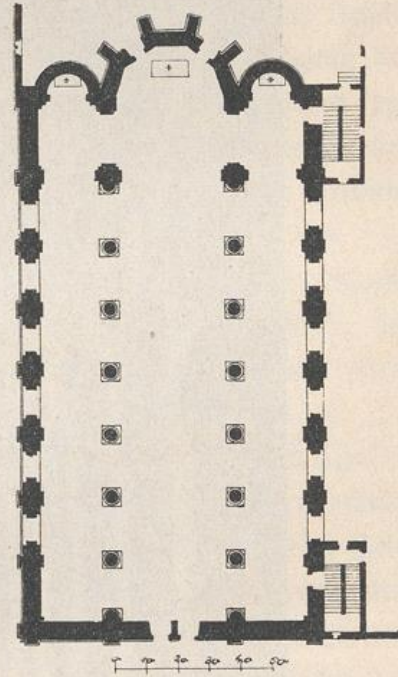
Brüssel. Jesuitenkirche. Grundriß. Erster Plan.
